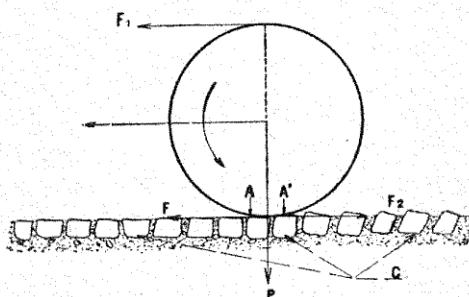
Effet du passage d'une roue de camion sur les cailloux de la chaussée.
